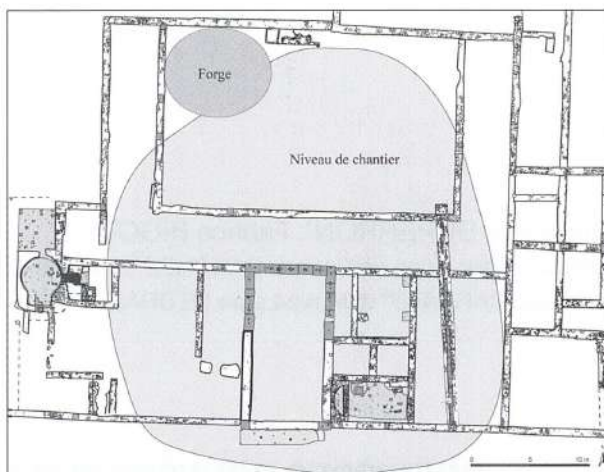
Plan du bâtiment à cour centrale avec l'emprise des niveaux de chantier (en gris) et la localisation de la forge liée au chantier.
